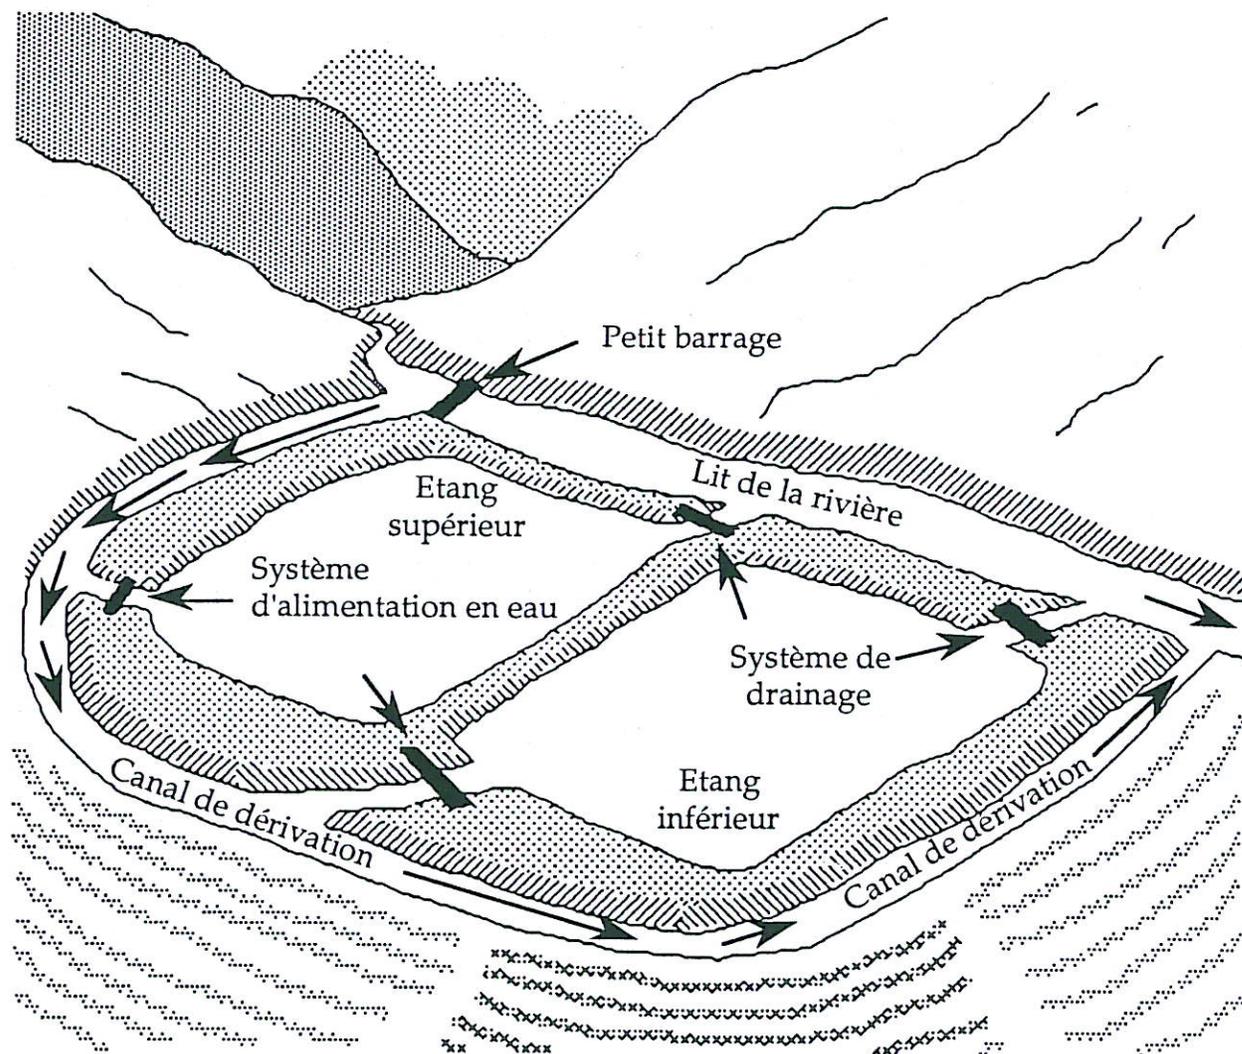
Etangs en terrasse avec canal de dérivation pour évacuer l'eau en excès autour des étangs pendant les hautes eaux.
